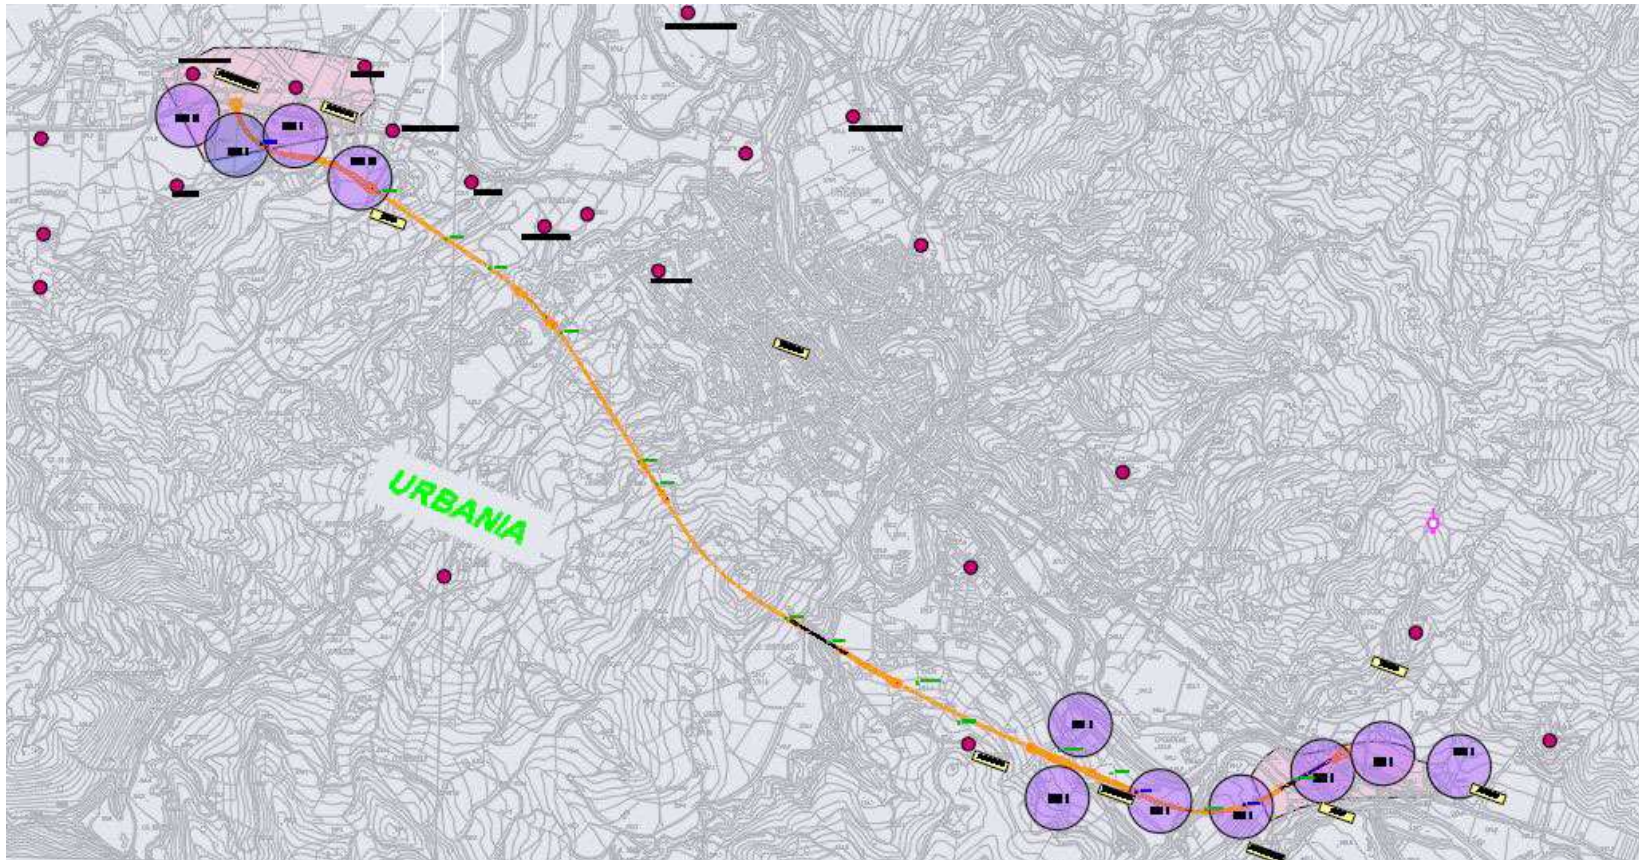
Planimetria di progetto con posizionamento dei pozzetti e dei sondaggi.
